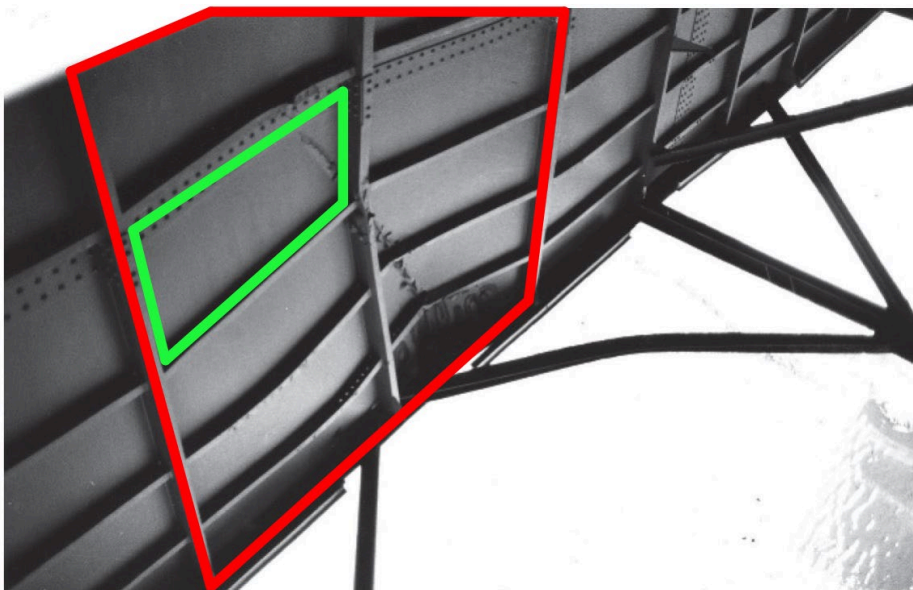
Einfaches Beispiel für geometrische Imperfektion infolge Schweißens
